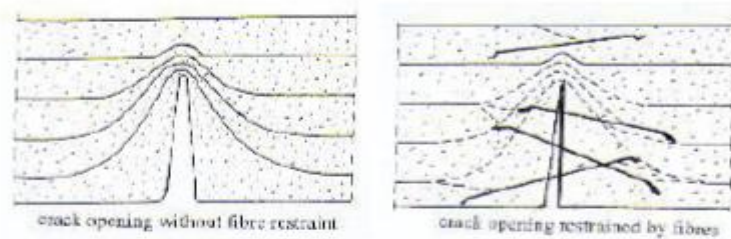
Effet de retardement de la fissuration du béton avec fibres.
